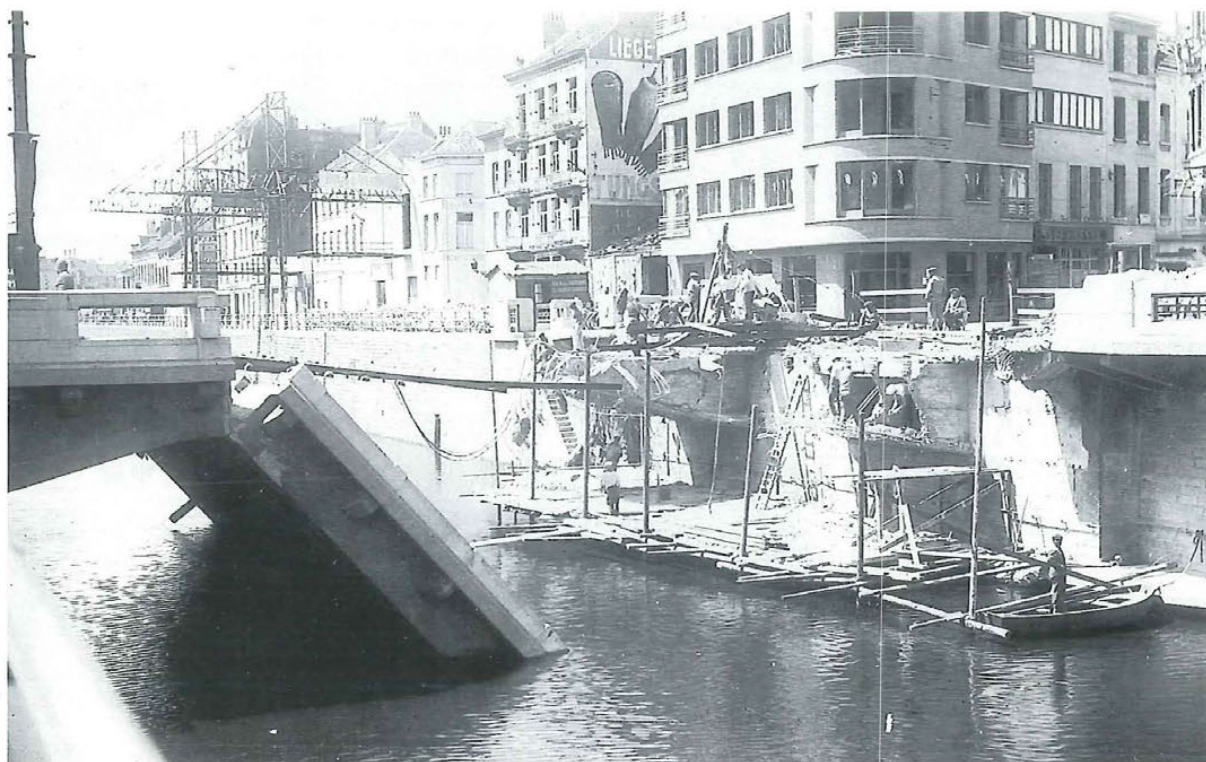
Bruxelles. Destruction du pont de la porte de Flandre en 1940.
